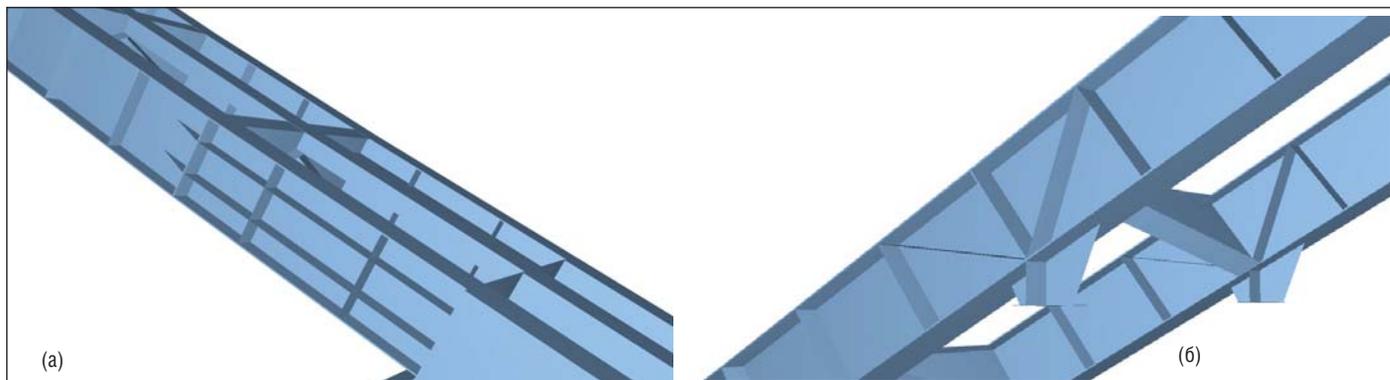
Усиленный участок основной балки: а) у распорного фундамента; б) в пролете над опорной колонной
